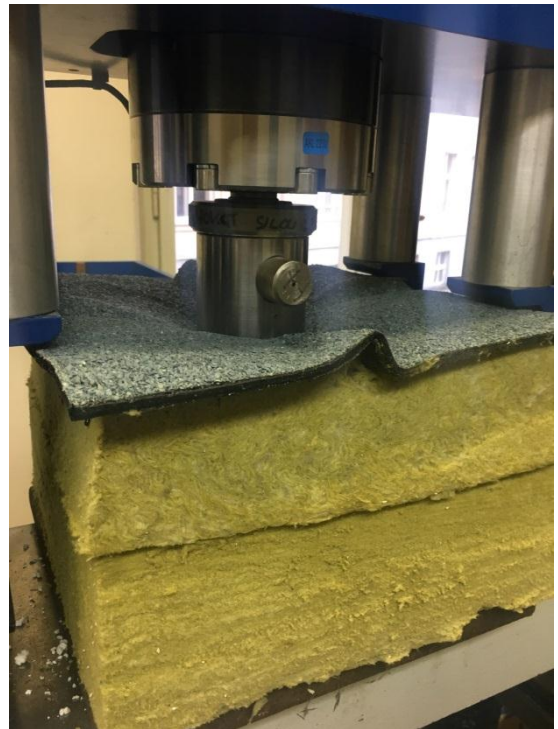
Univerzální tlakové zařízení (příprava před zkouškou)
